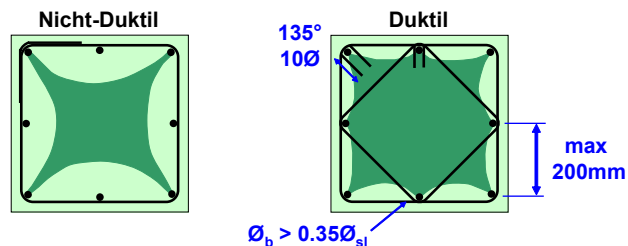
Anordnung der Umschnürungsbewehrung bei Stützen. (Heller Bereich: abgeplatzter Beton. Dunkler Bereich: Betonkern).
